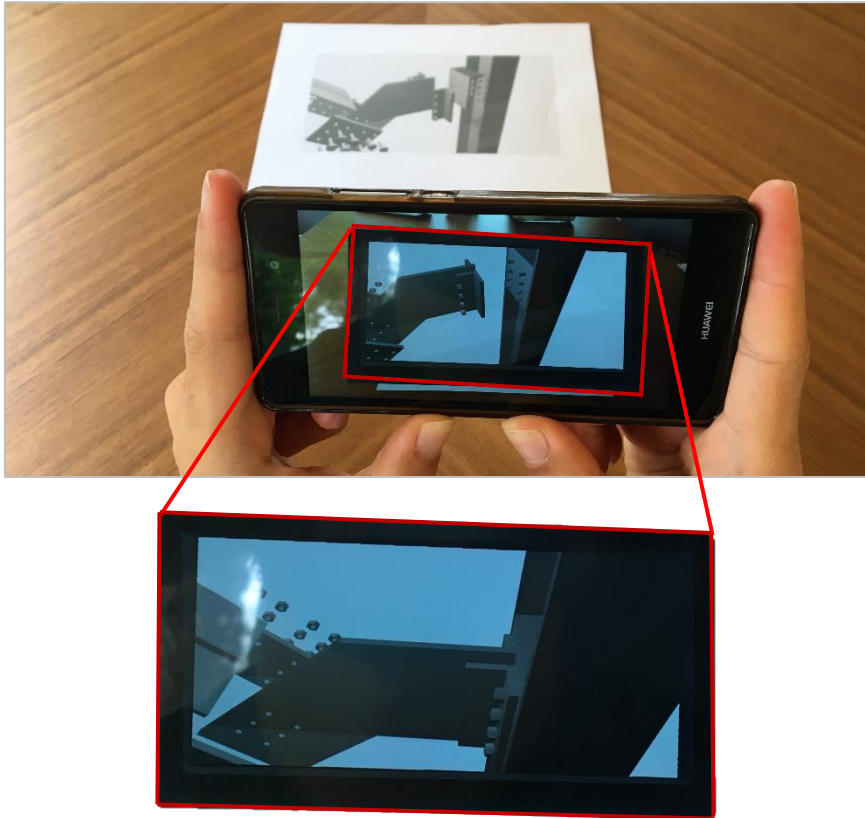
Visualización de RA de montaje de detalle constructivo en edificación.
